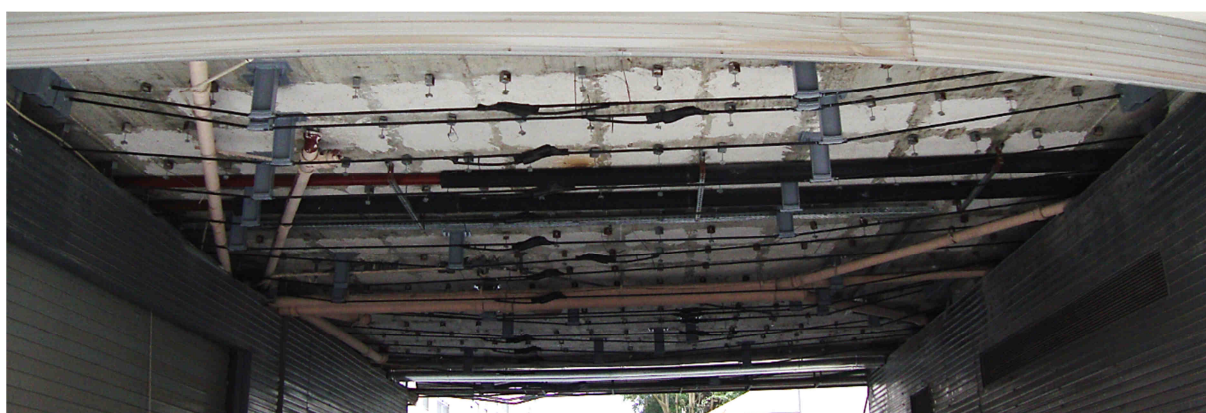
Vista geral da laje com o pré-esforço exterior aplicado.
